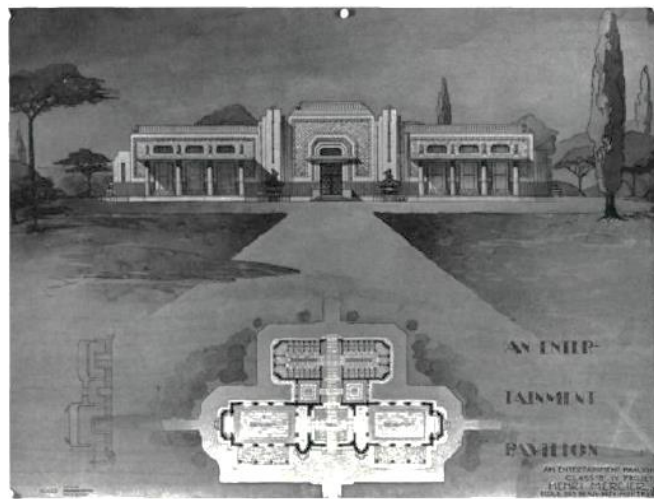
Plan, élévation, coupe d'un pavillon de divertissement Photo© Robert Hebert
